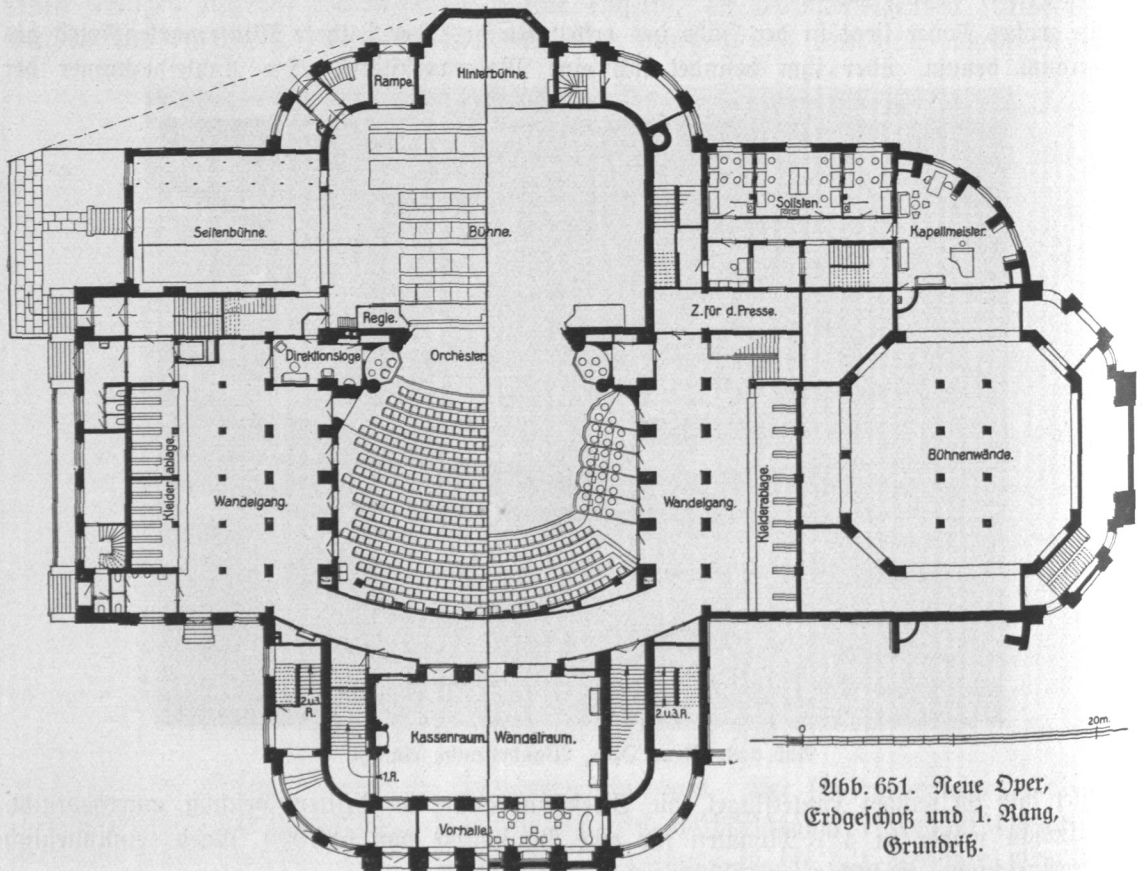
Neue Oper, Erdgeschoß und 1. Rang, Grundriß.
